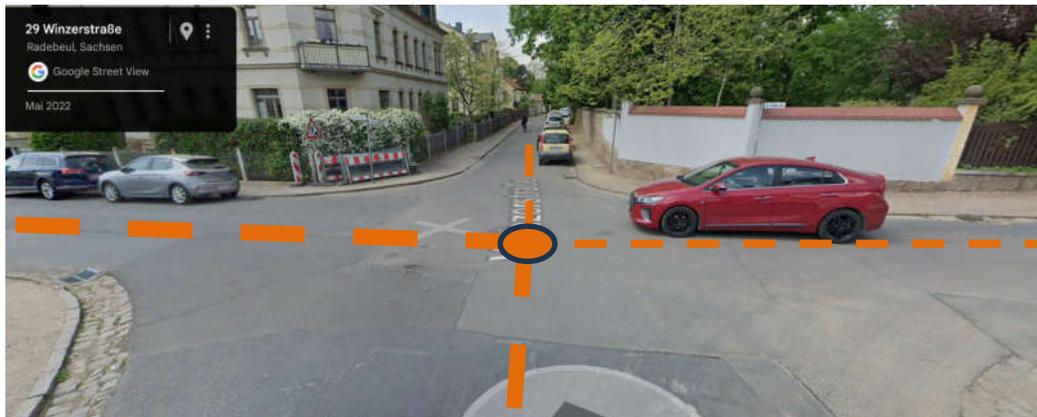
Winzerstraße, Bauende Dr. Külz-Straße, Blick Radebeul West, Schacht 7.7.3-4
